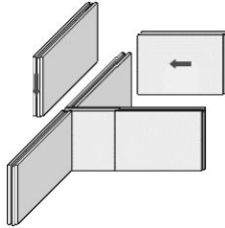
Монтаж плит при пересіканні перегородок одна з одною
